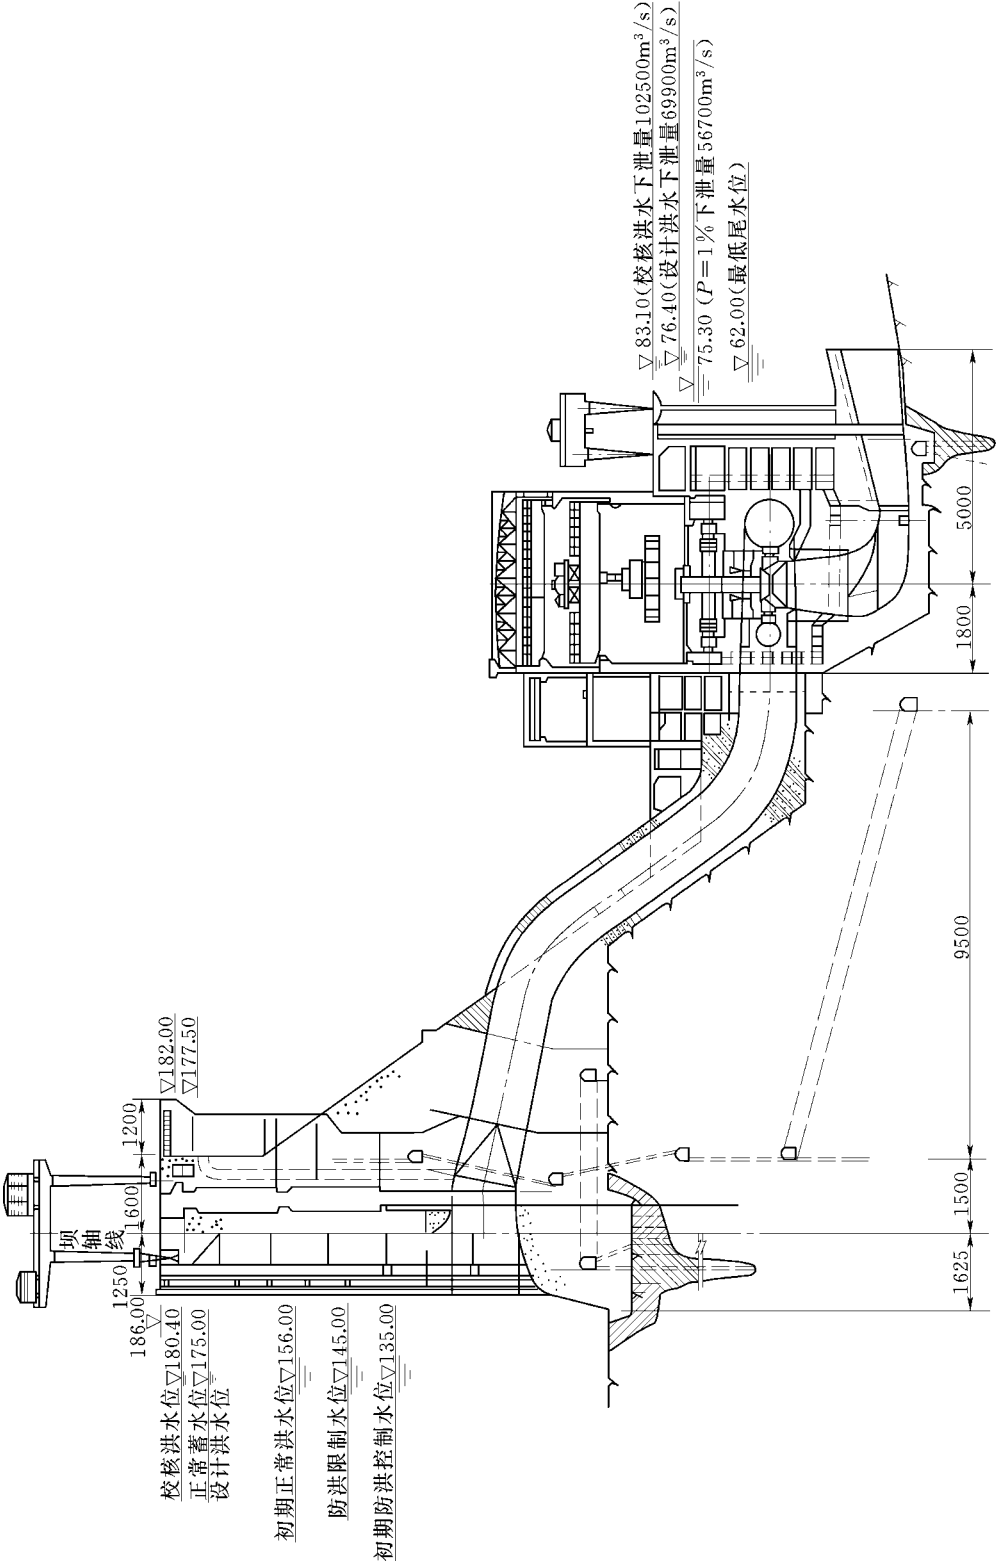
三峡大坝 3 坝段典型剖面图 (单位: m)
